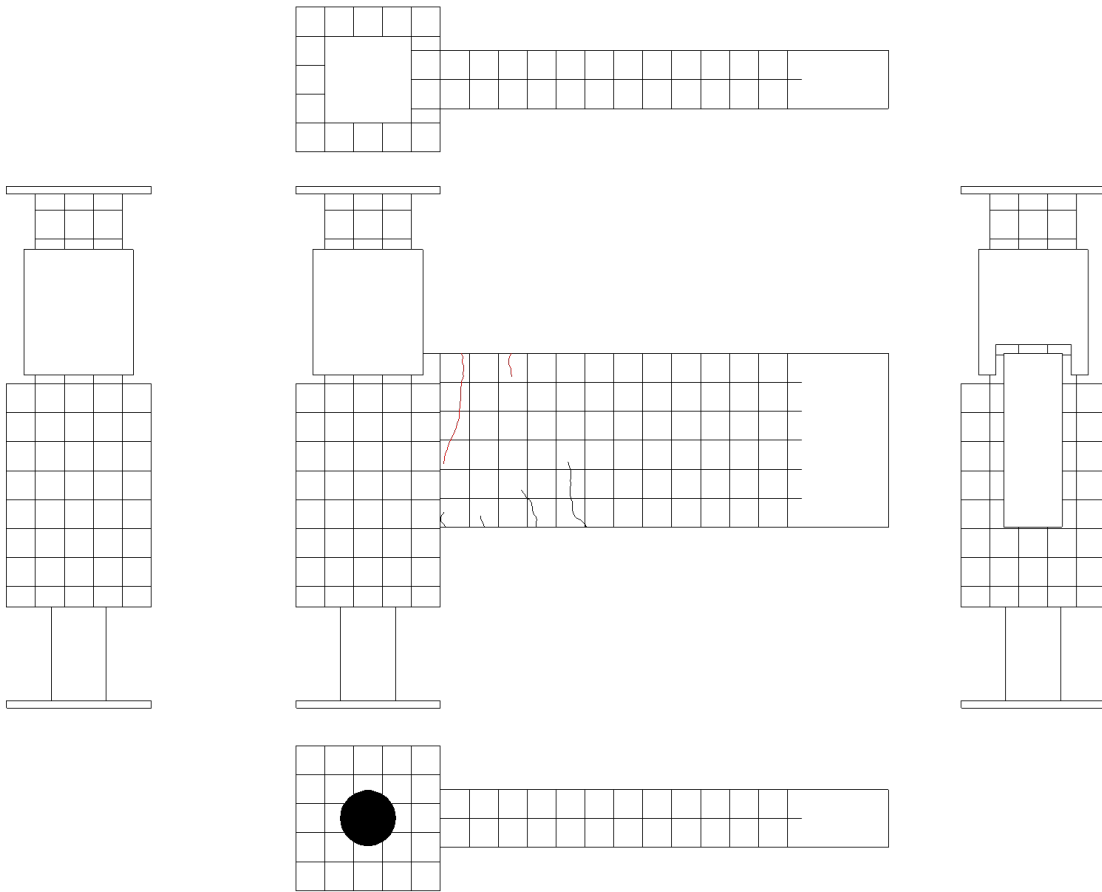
試験体 A-2 ひび割れ状況 (10Cycle)
